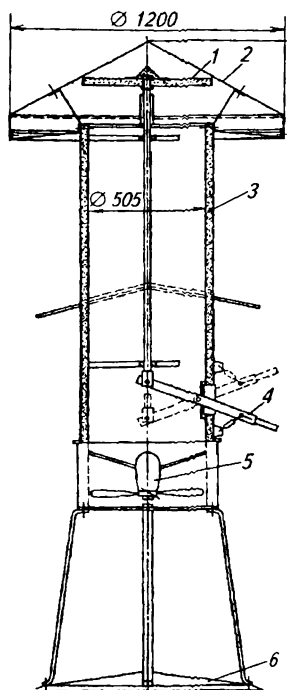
Схема устройства приточной вентиляционной башни:
